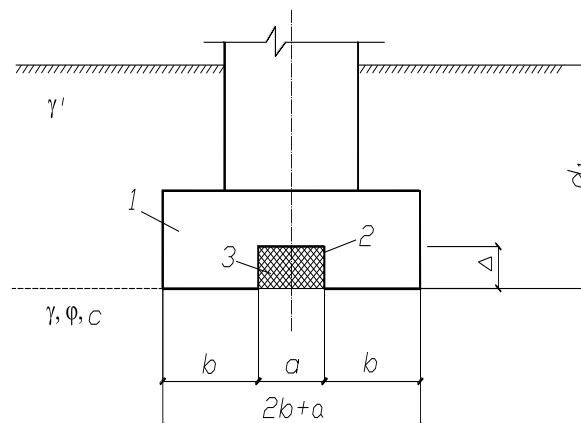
Ленточный фундамент с продольным вырезом по подошве
